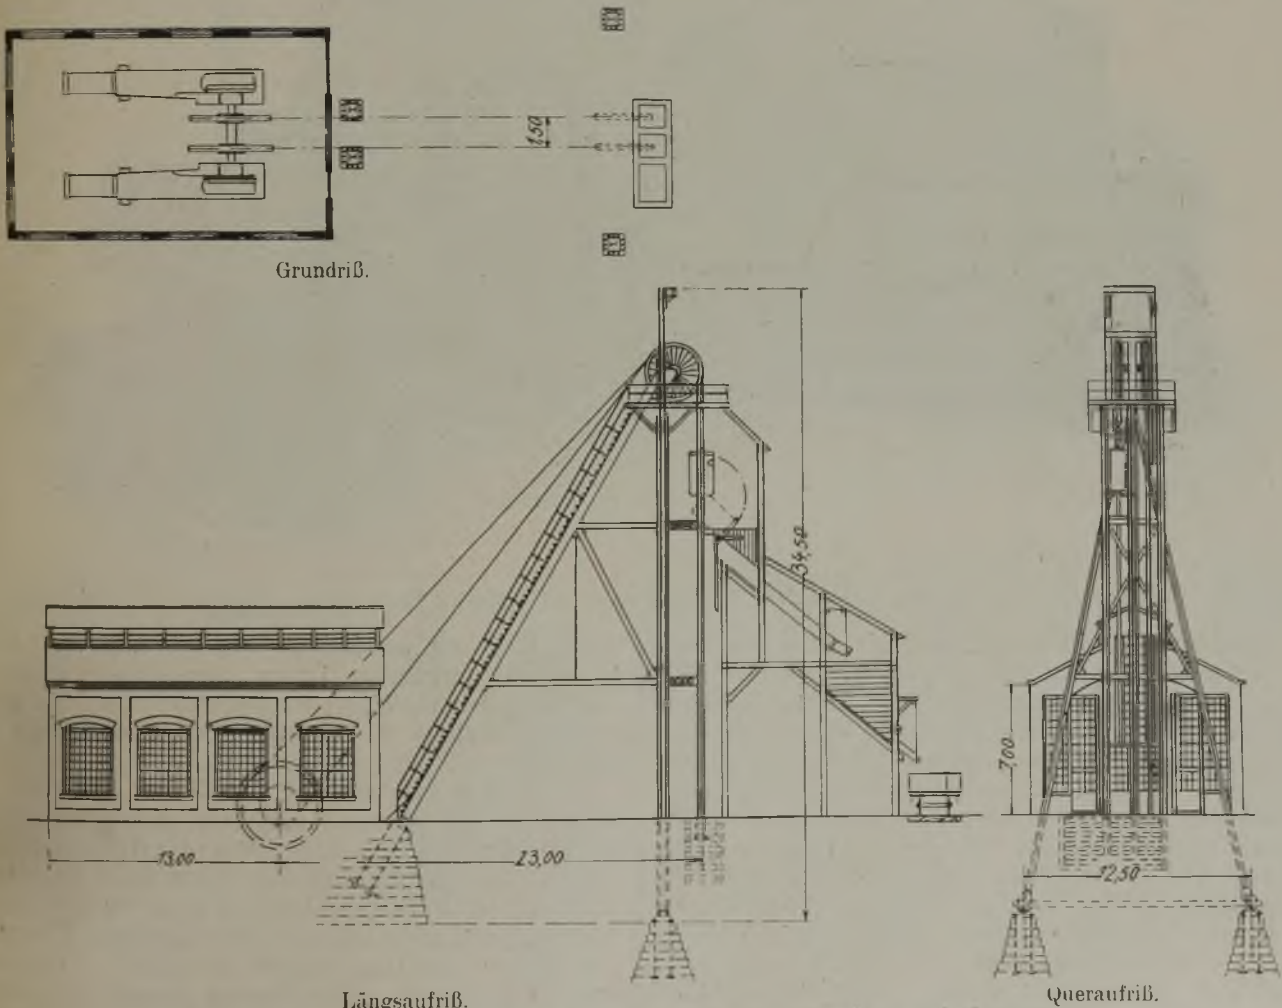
Eisernes Schachtgerüst mit Ladetaschen für seigere Skipförderung.
